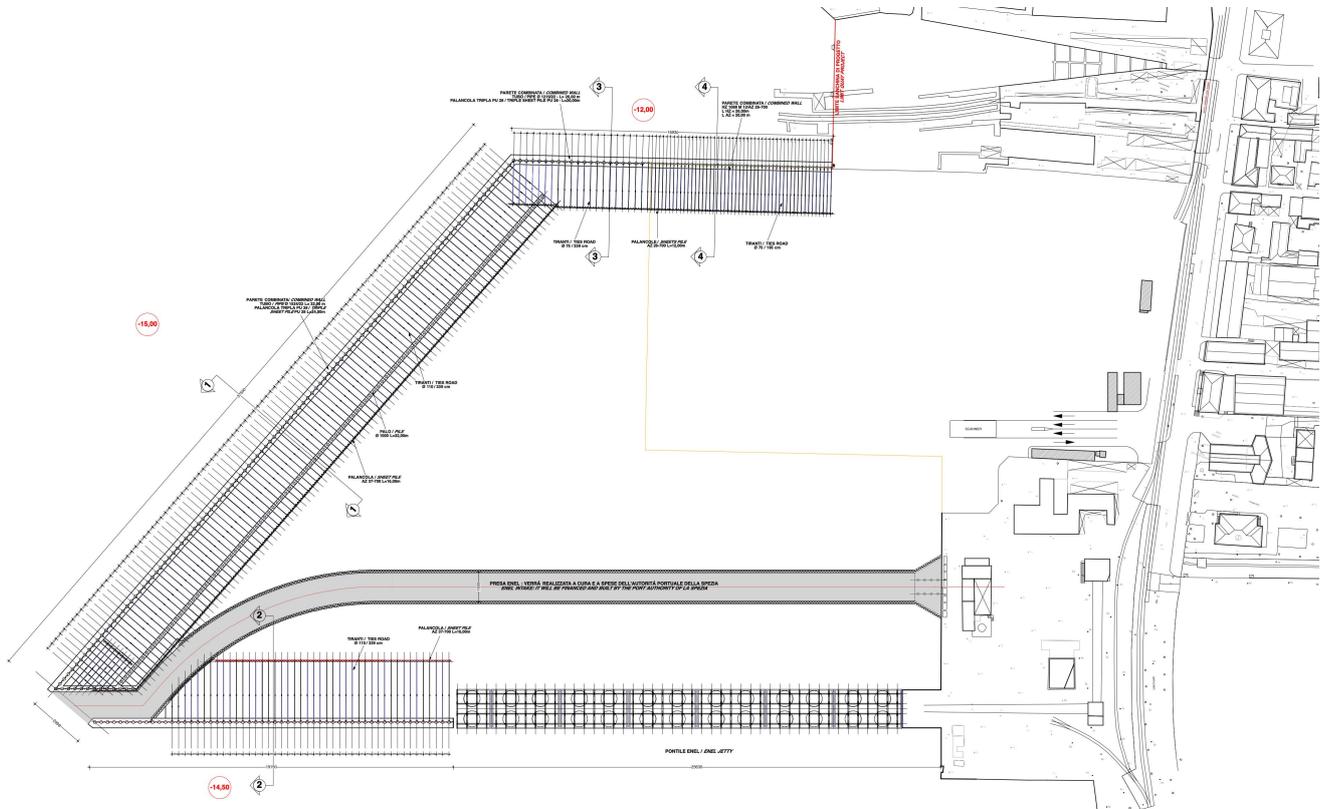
interventi strutturali, riempimento e canale presa ENEL
